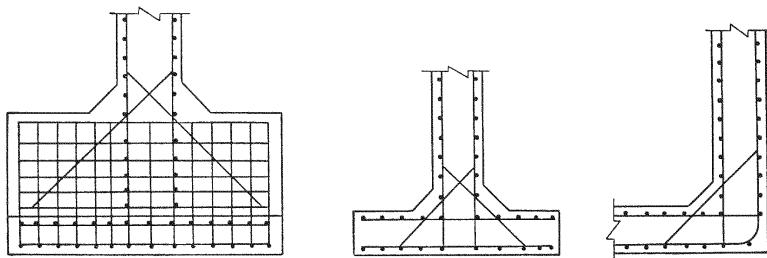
門柱と堤柱との結合部、堤柱と床版との結合部の配筋
